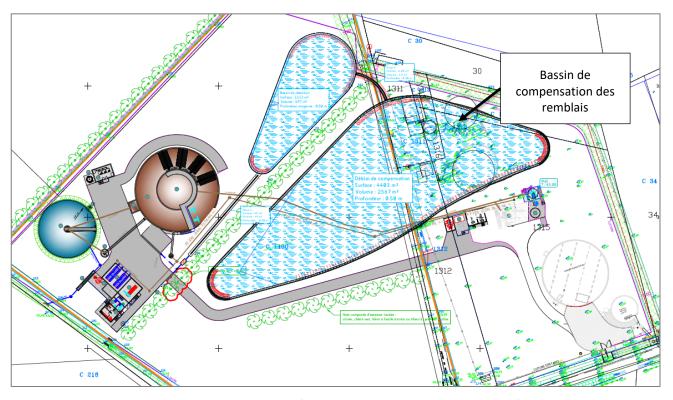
Plan projet (source : Etude hydraulique Cereg, Avril 2021)
